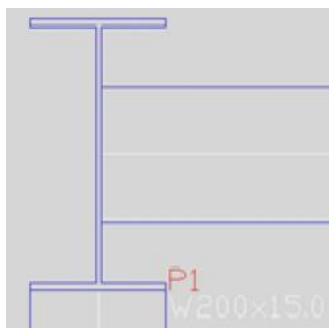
Pilar Metálico perfil W inserido em projeto de arquitetura.
